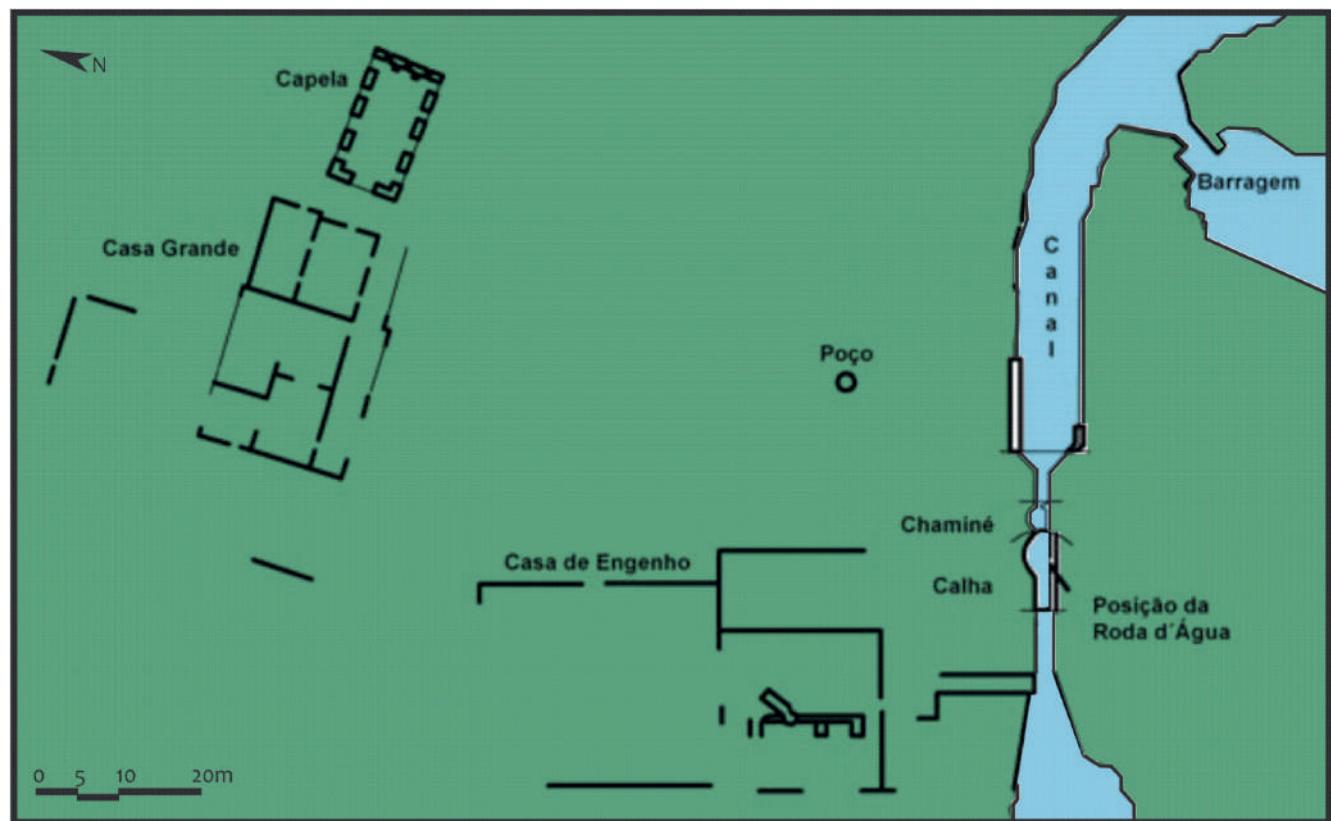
Planta geral do Engenho Murutucu, Belém.
